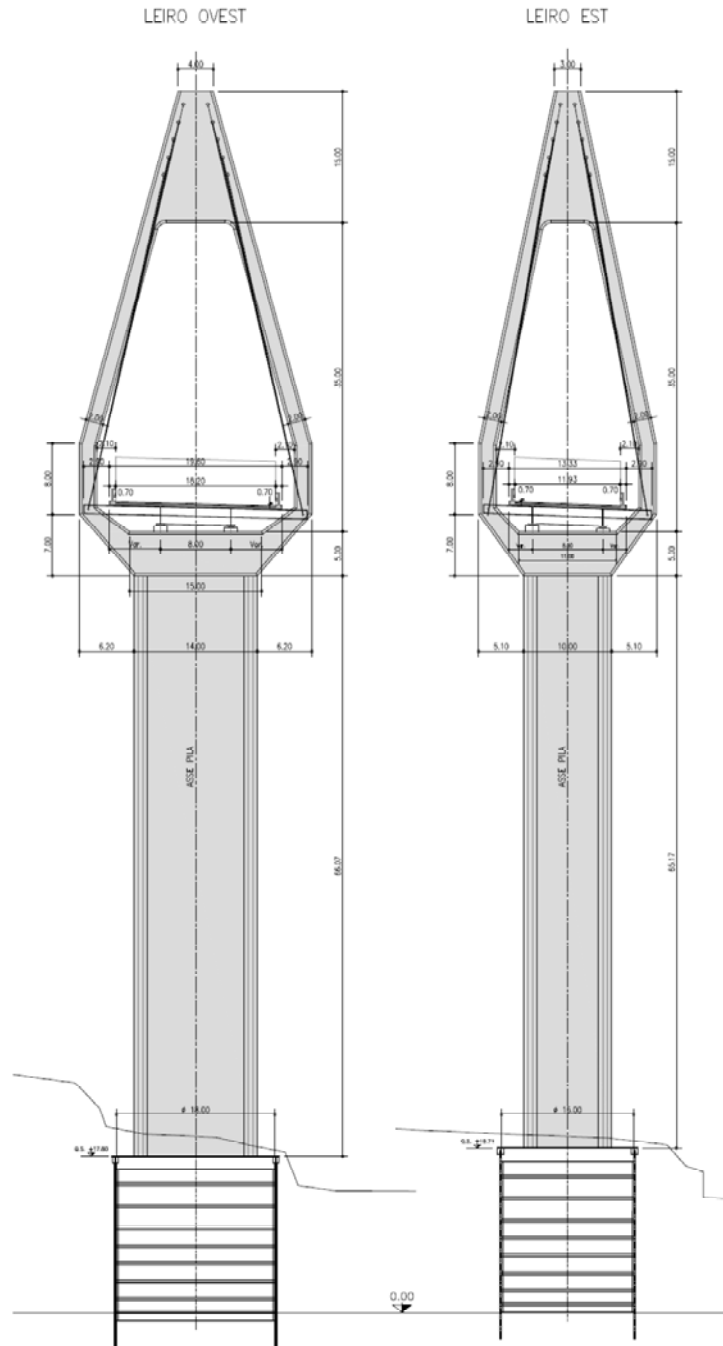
Studio soluzione alternativa: viadotto strallato - pila
